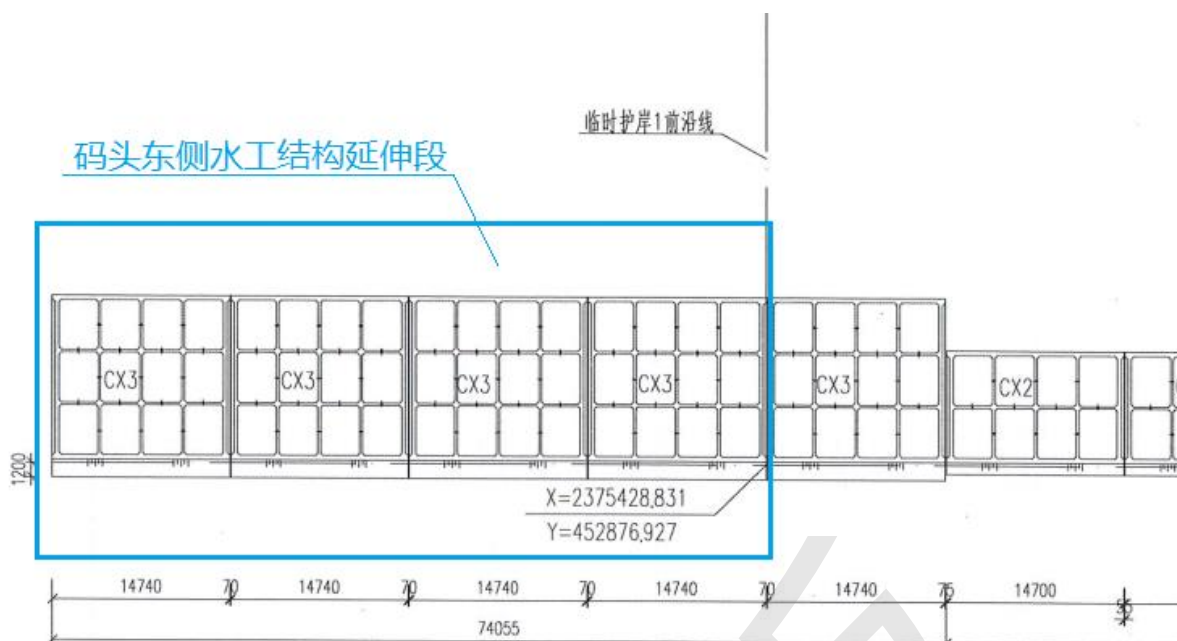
码头东侧水工结构延伸段平面布置图（摘自附图 7）
